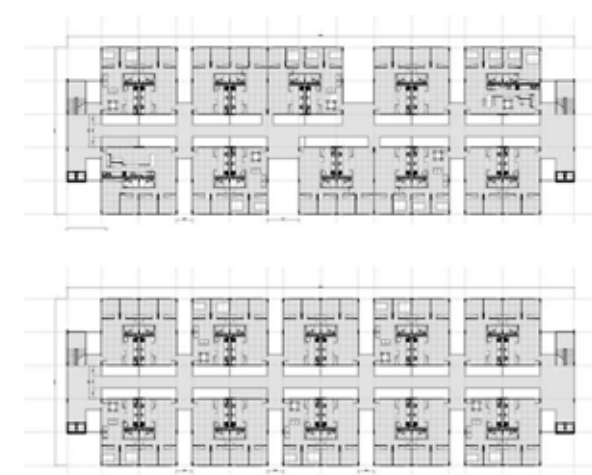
desenho projeto pavimento tipo edifícios habitação. Fonte: elaboração própria.
